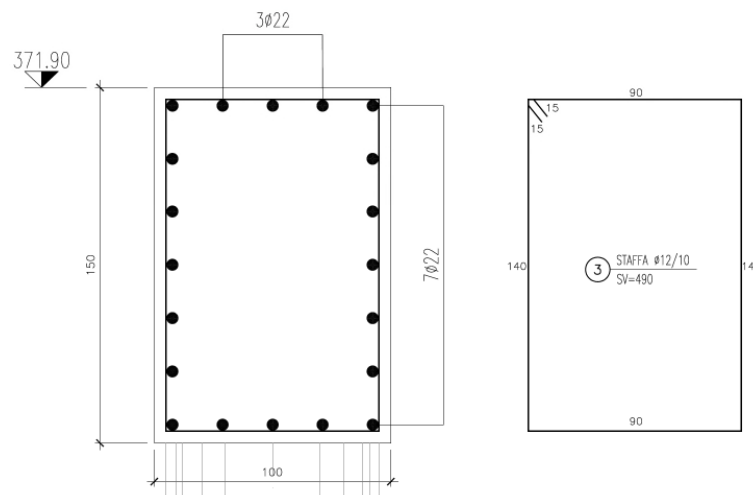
Verifica strutturale SLU - Sezione 2
